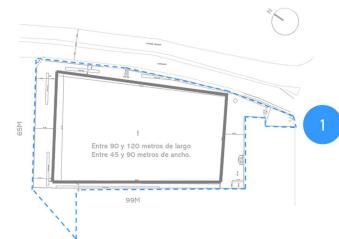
Planta de Levantamiento del Sitio, Fuente: Elaboración Propia
